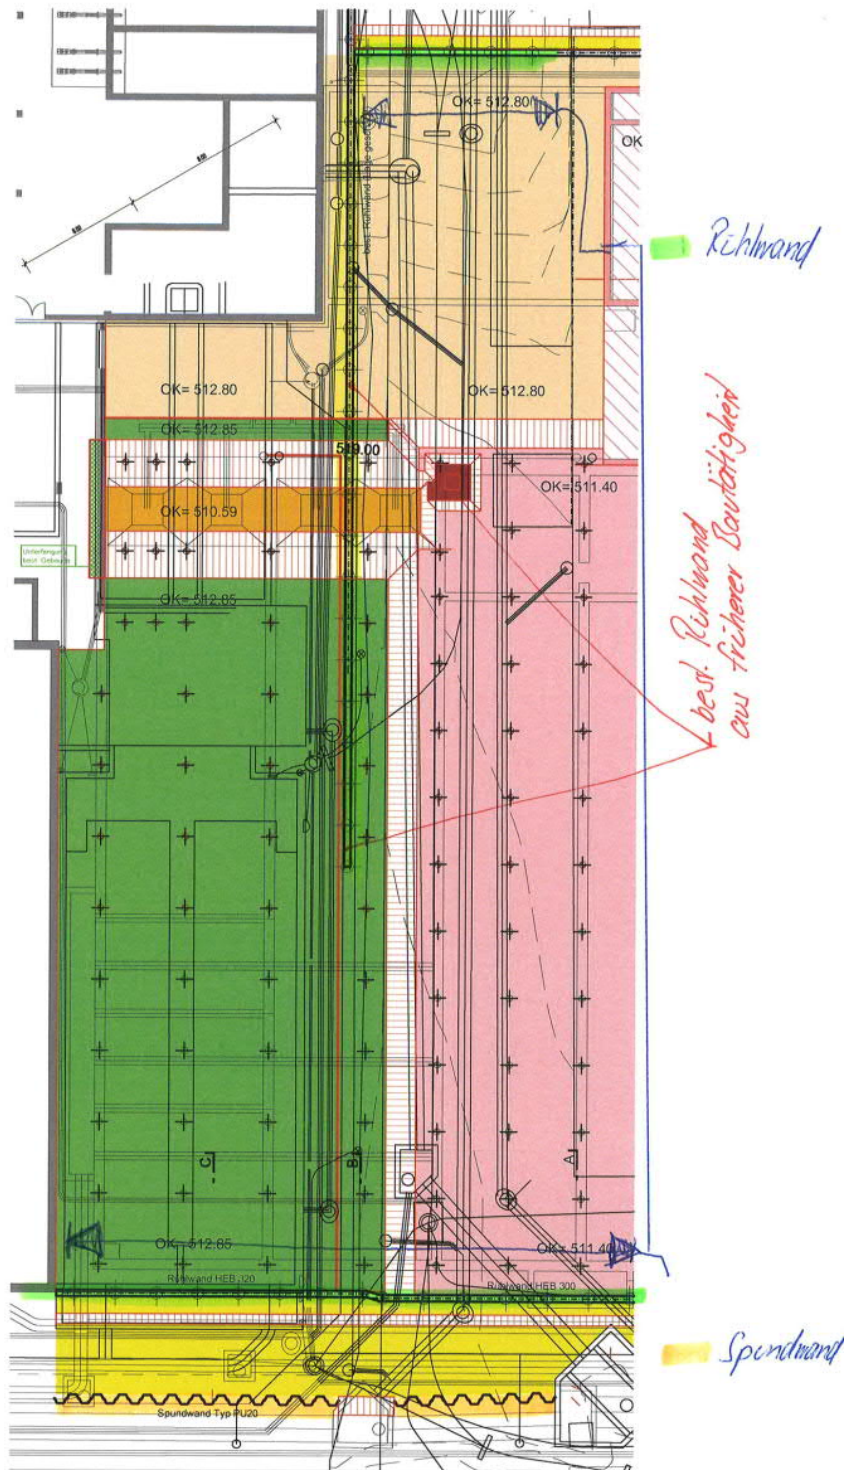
Baugrube Etappe 3a; Grundriss Baugrube
